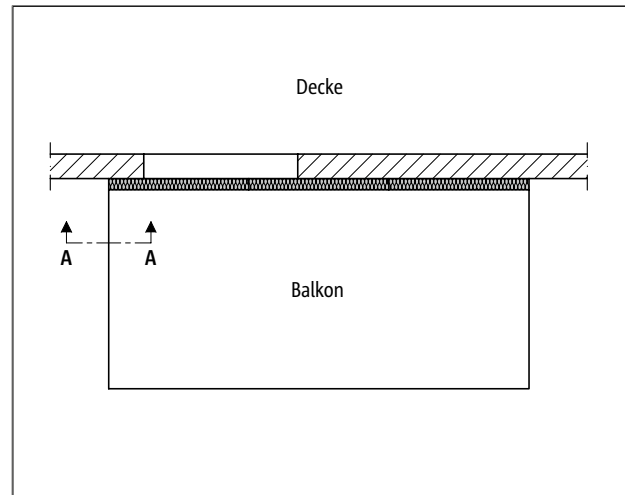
Schöck Isokorb® RT Typ K: Balkon frei ausragend
